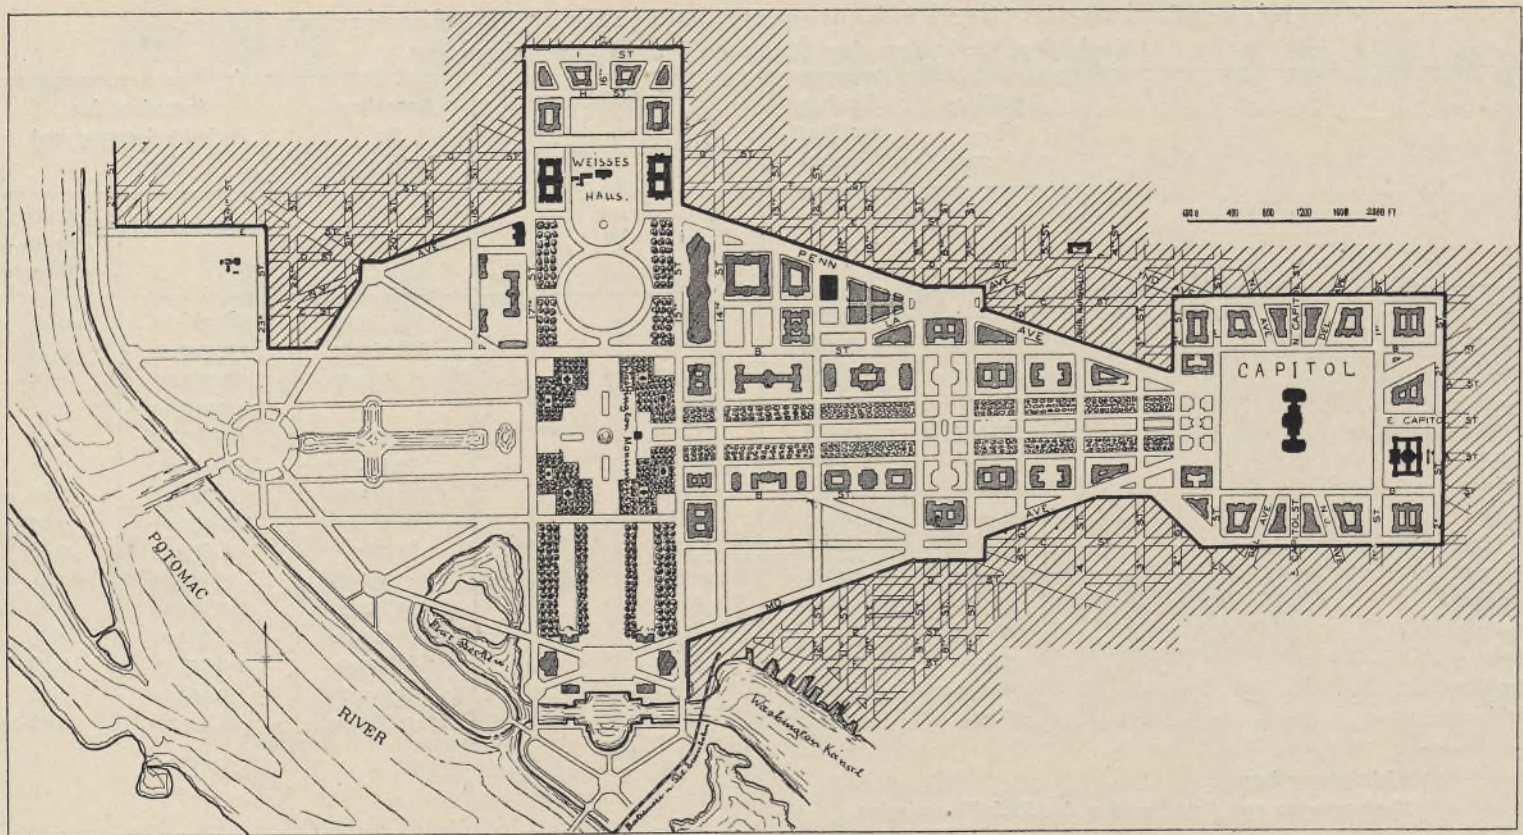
Lageplan der Mall mit zukünftiger Erweiterung und Lage der öffentlichen Gebäude.
